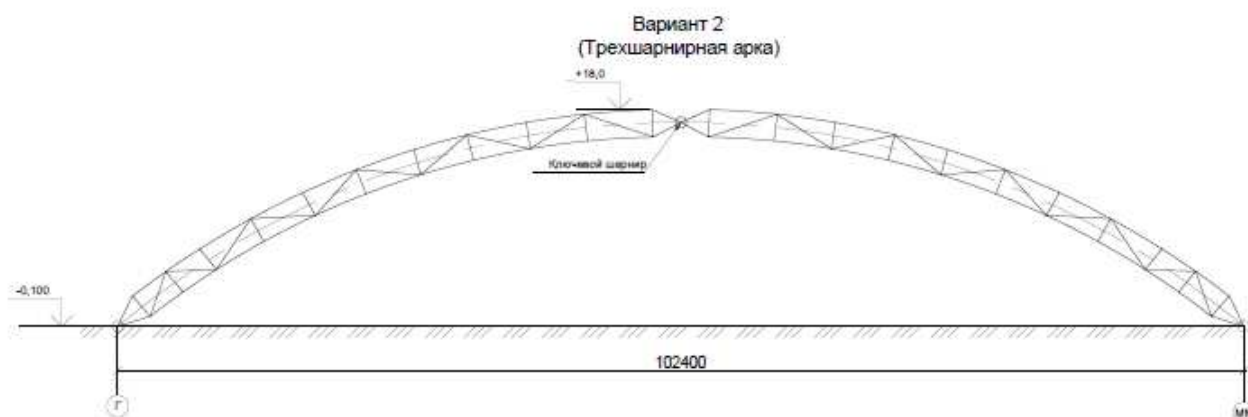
Вариант конструкции покрытия (арка)
